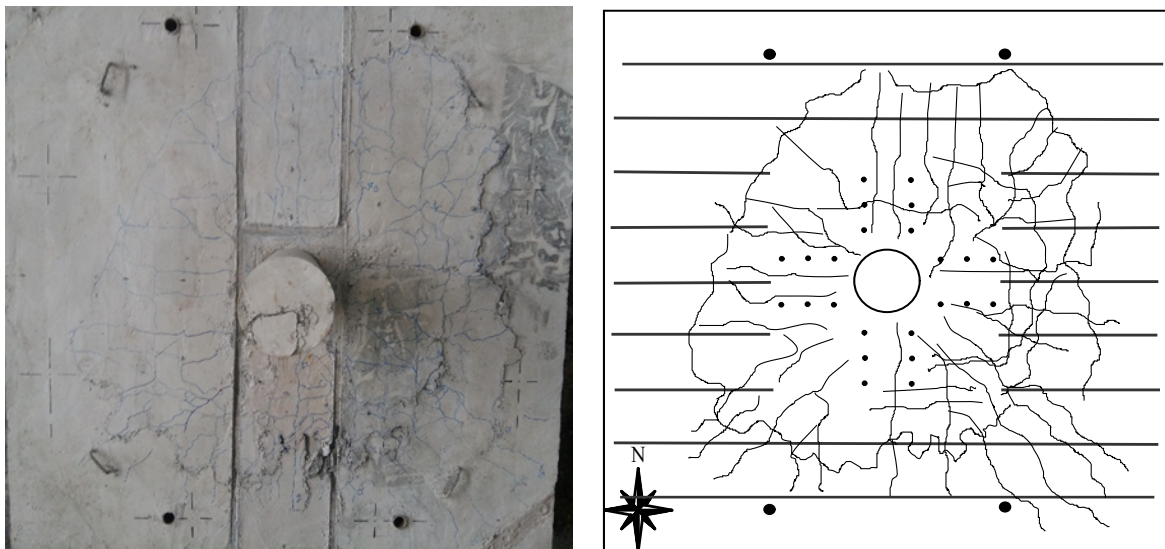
Mapa de fissuração - Laje BD-A03
